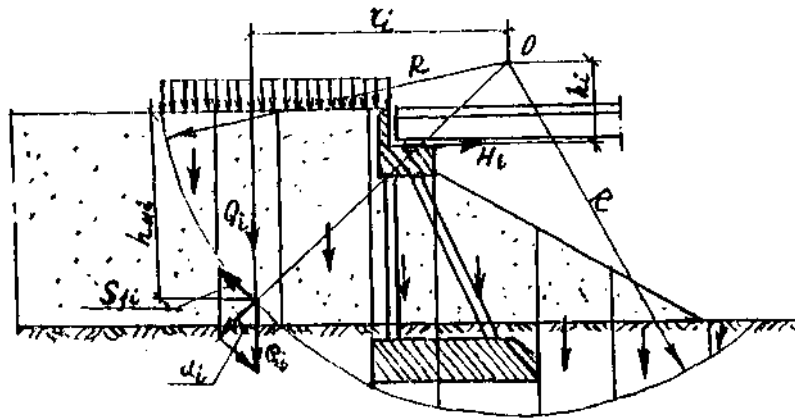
Схема к расчету опоры на глубокий сдвиг
